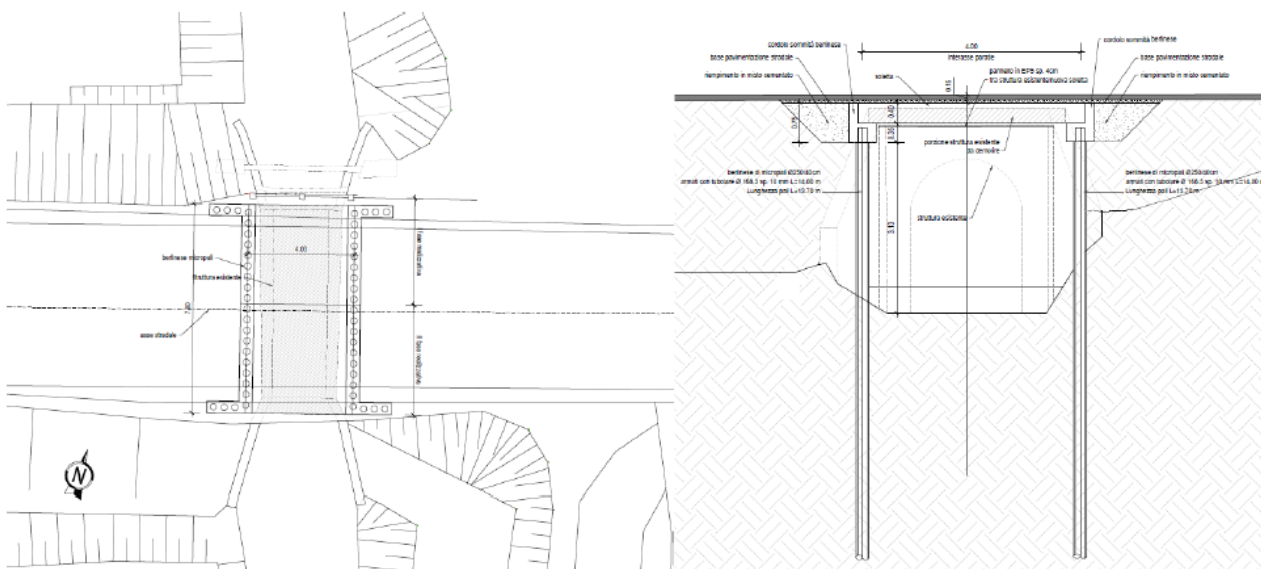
Planimetria e sezione di progetto attraversamento idraulico al km 47+200 della SS 14 (Fonte: All. 3 alla Lista di Controllo – Relazione Tecnica Generale)
